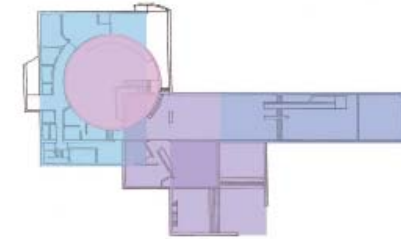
Planta de Implantação dos três elementos da intervenção
